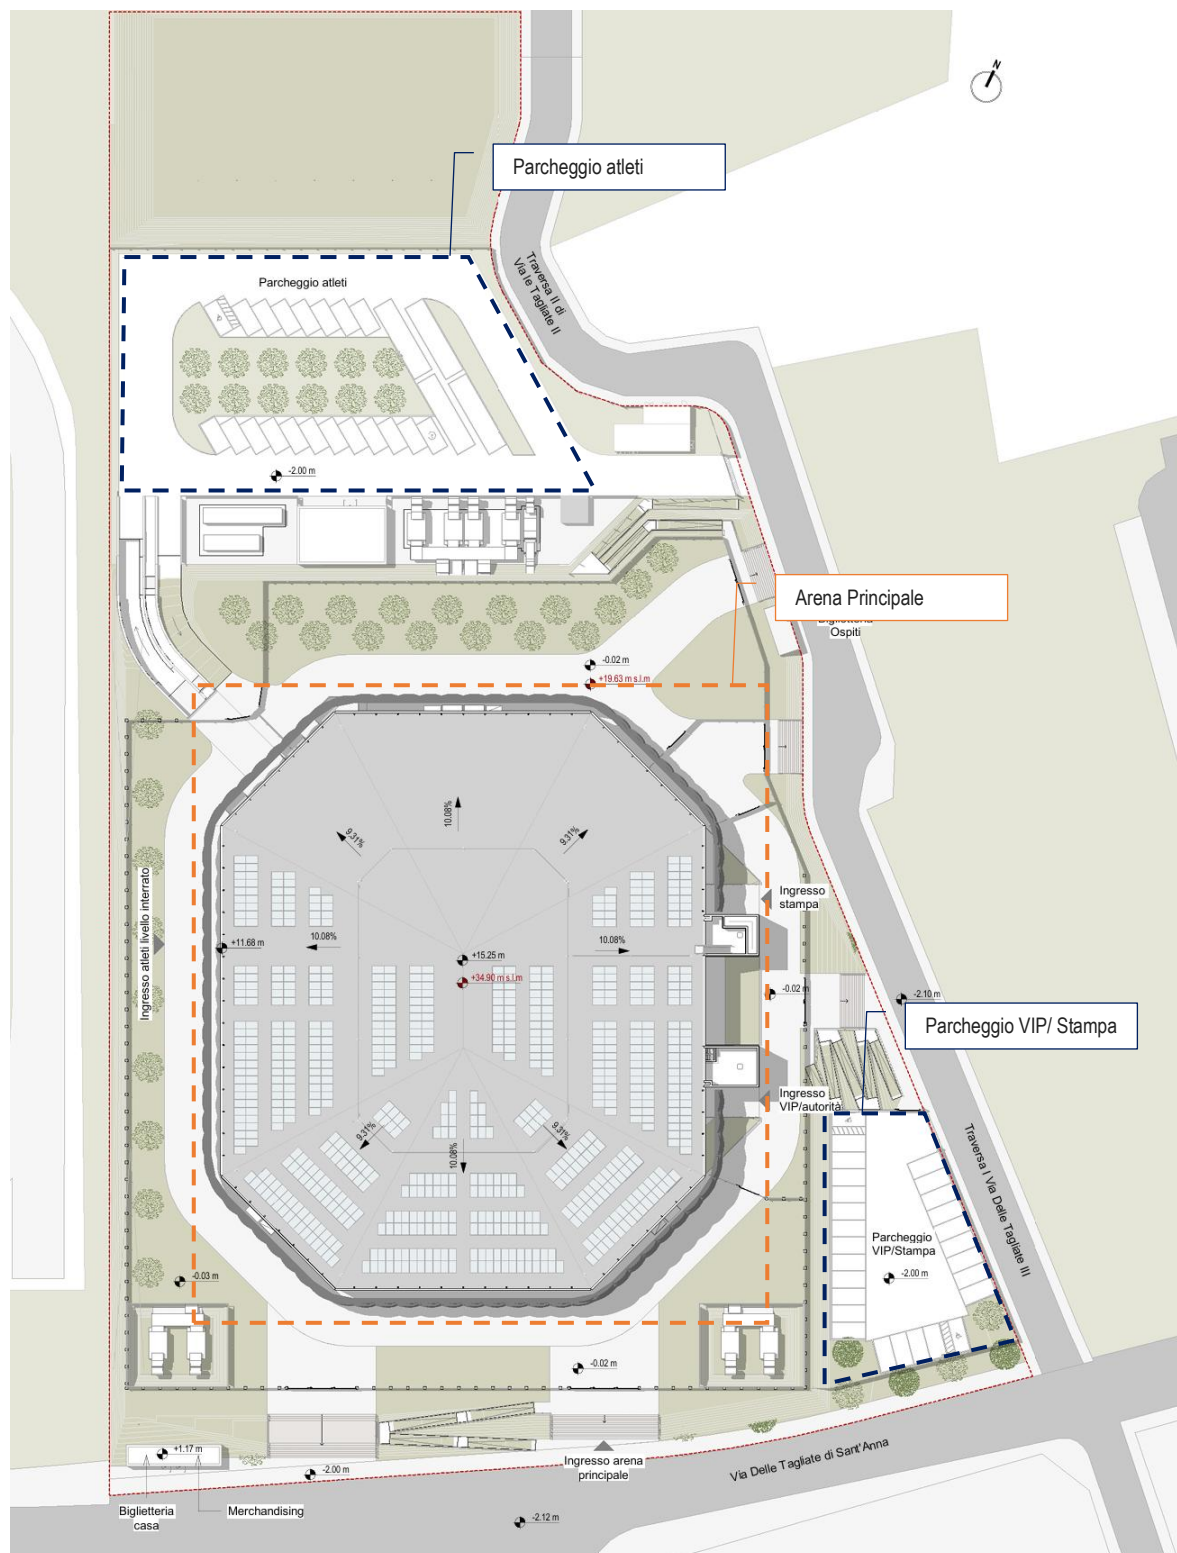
Planimetria generale dello Stato di progetto (fonte: ATI Project).
